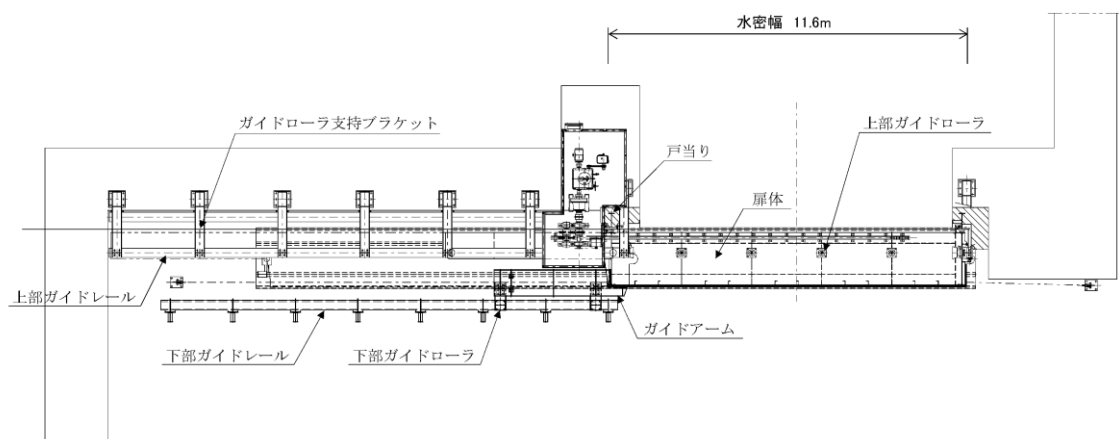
(2) 防波扉の構造図（鋼製扉体，平面図）
